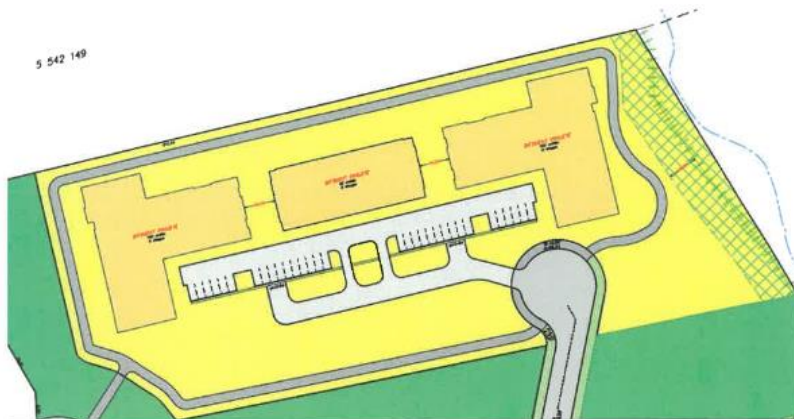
Plan d'aménagement d'ensemble des zones R-12 et CONS-6
